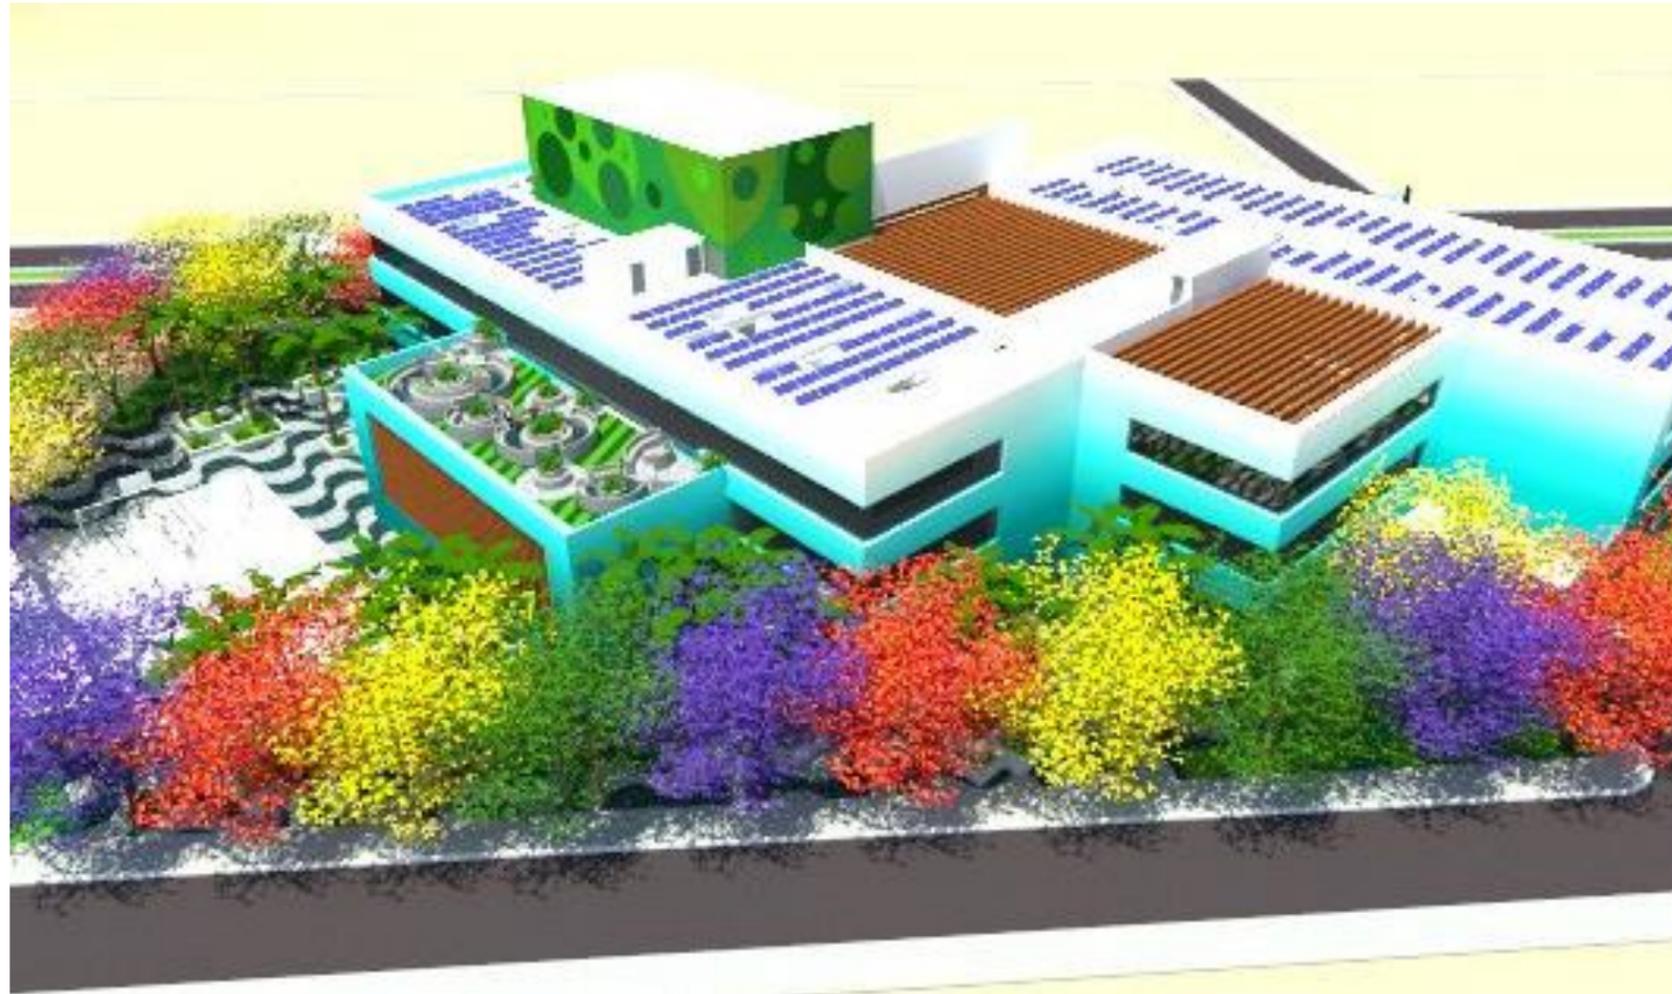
VISTA AEREA CONJUNTO. Fuente: Acervo personal.
